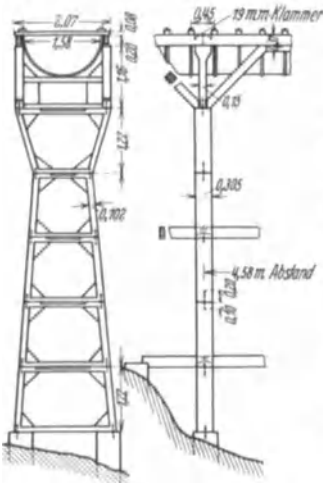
Gerinnegerüst aus fabrikfertigen Eisenbetonelementen. (Engng. News Rec., 15. Mai 1919.)
